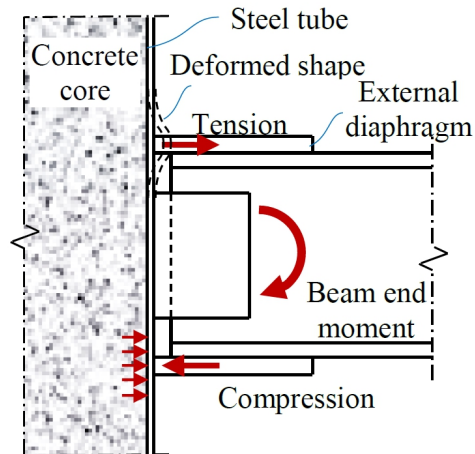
Ilustrasi kolom concrete-filled steel tubular (Sumber: Kajima, 2004)
